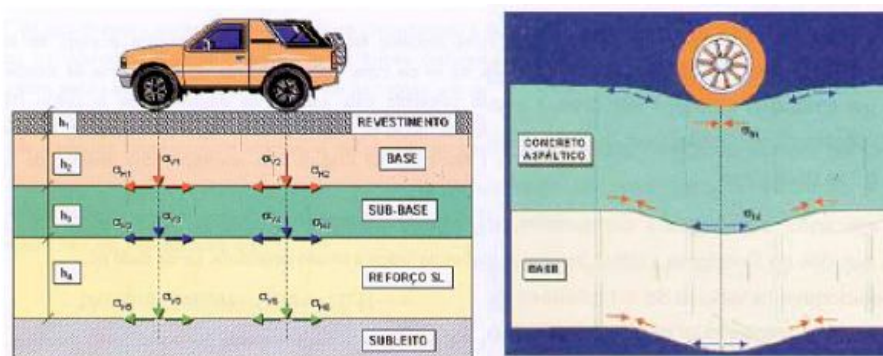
Estrutura típica de um pavimento e transferência das cargas entre as camadas
